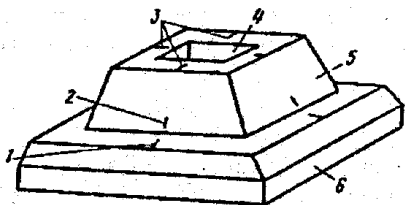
Схема ориентирных и установочных рисков на фундаменте и опорных башмаках колонны:
